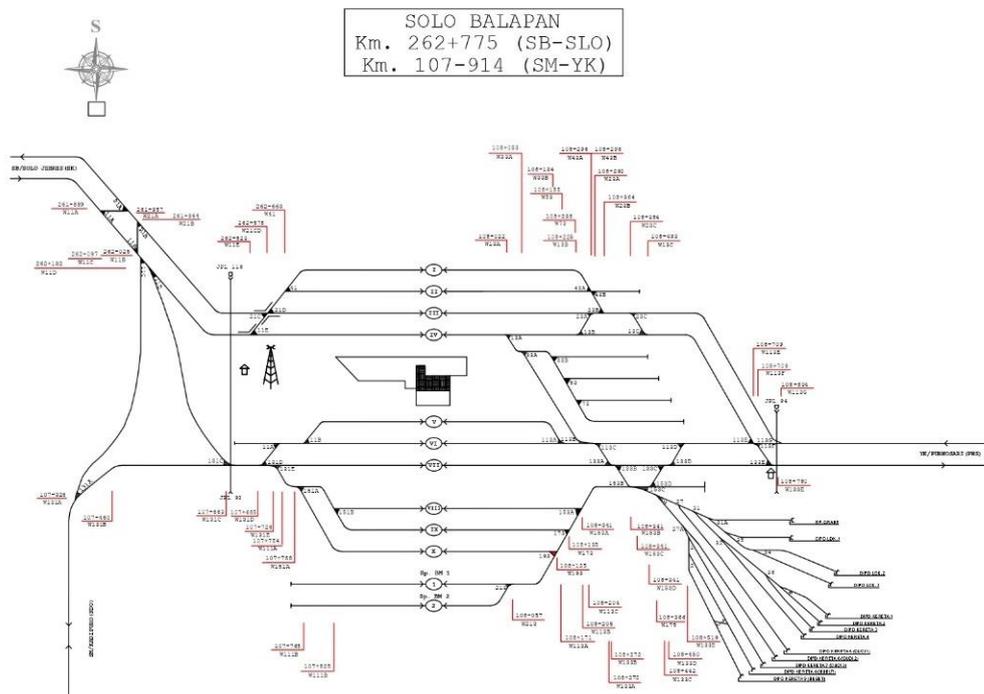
Layout Emplasemen Stasiun Solo Balapan
